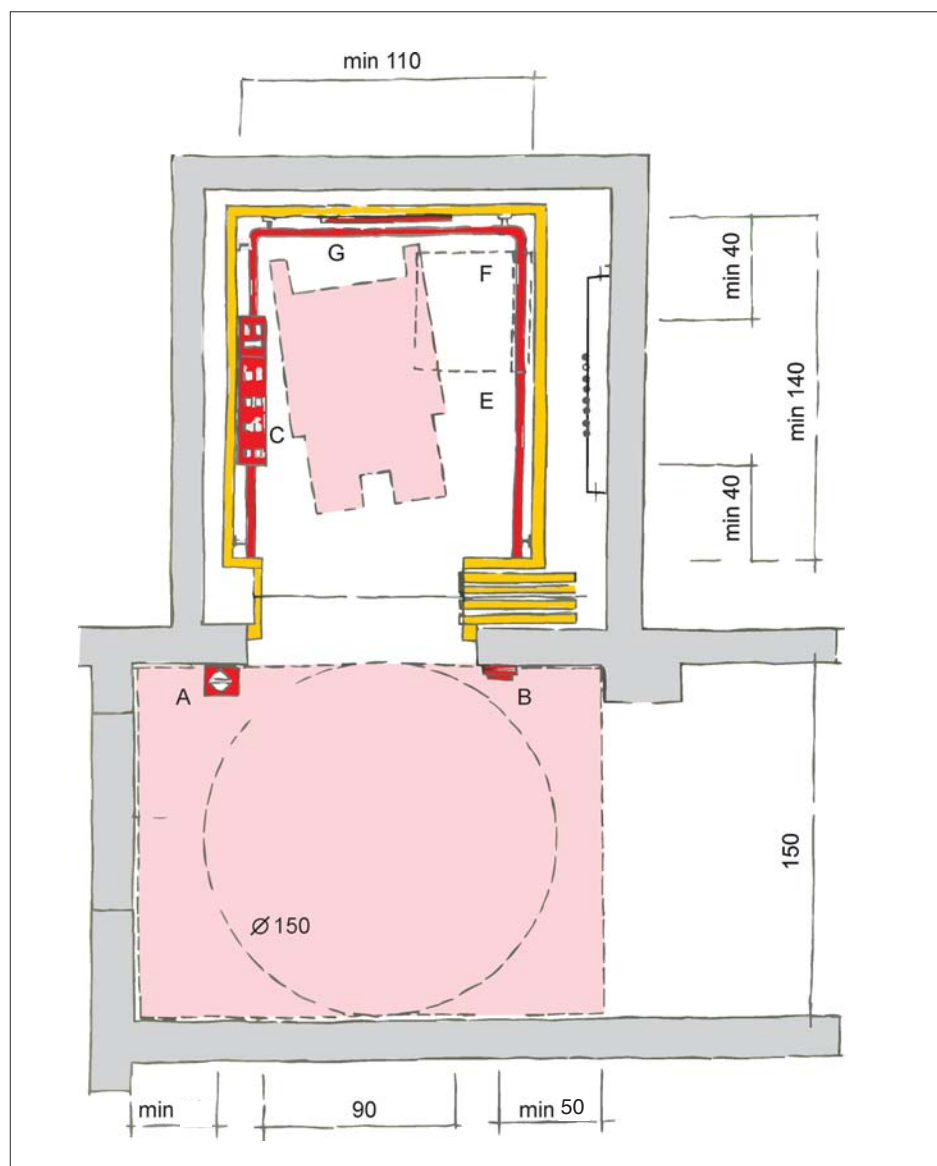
Grundriss zu Bild 1, Mindestabmessungen
